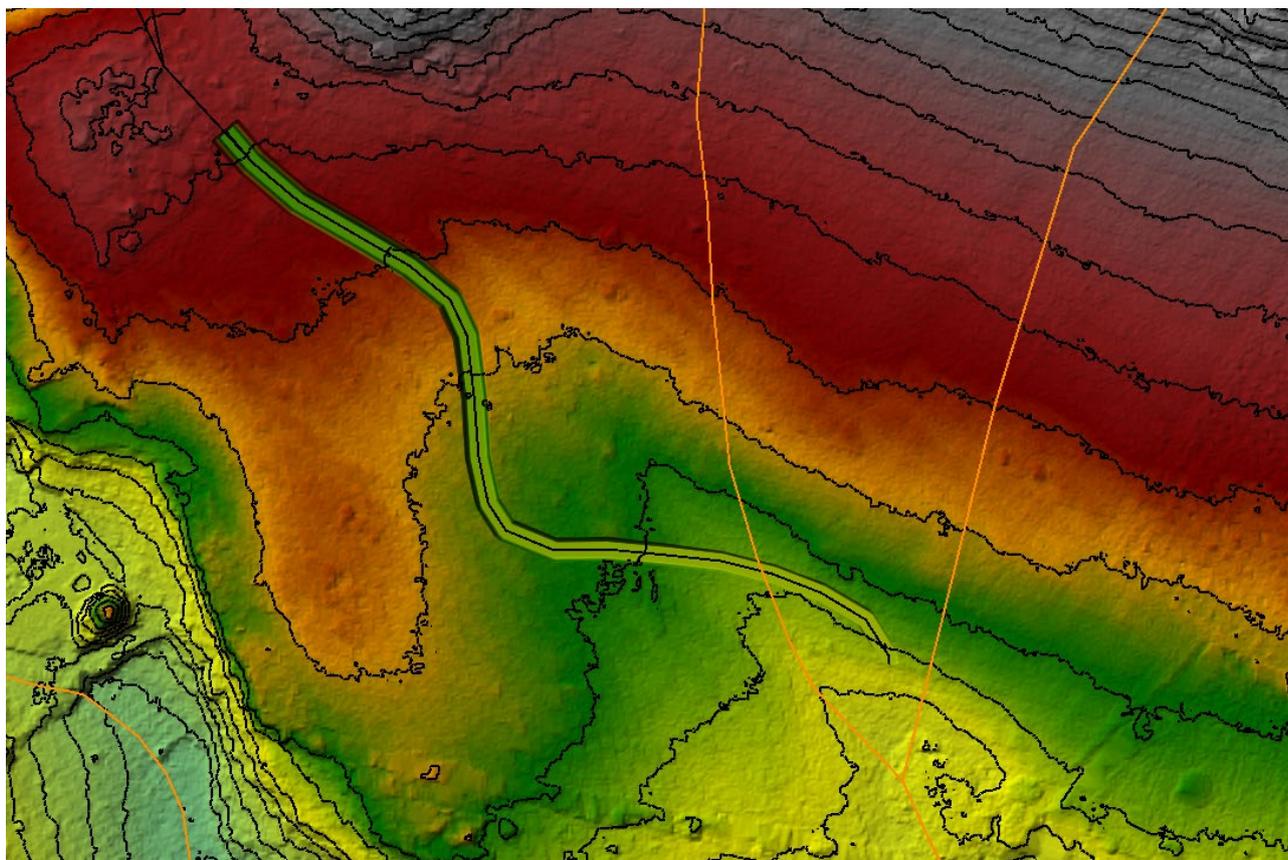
Planimetria canale centrale all'interno dell'area
